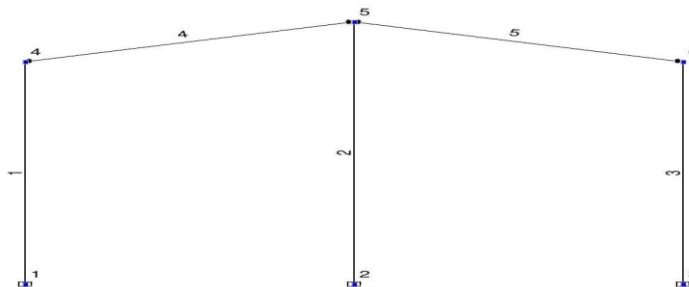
Розрахункова схема поперечної рами будівлі
